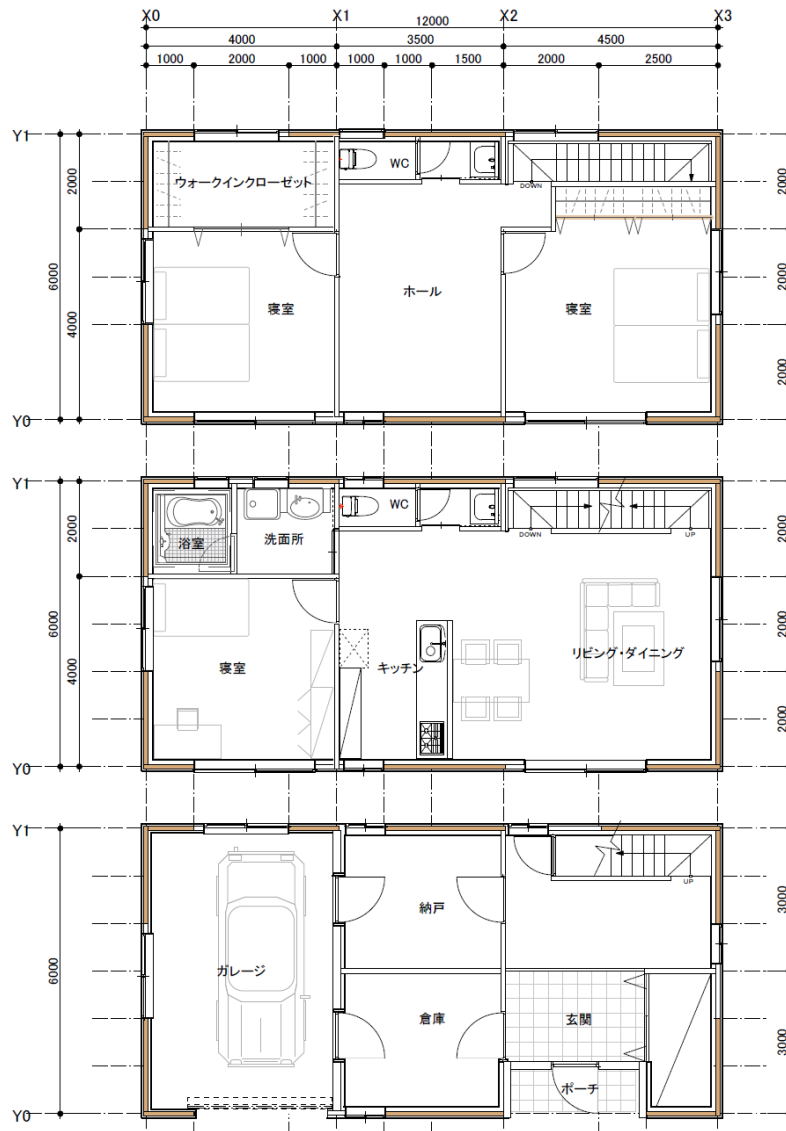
B 棟 (3 層) 試験体の各階平面図
